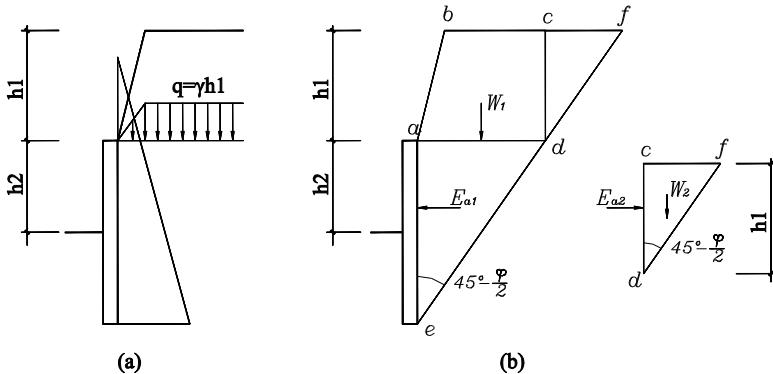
基坑上部采用土钉墙下部采用排桩或地下连续墙时的
